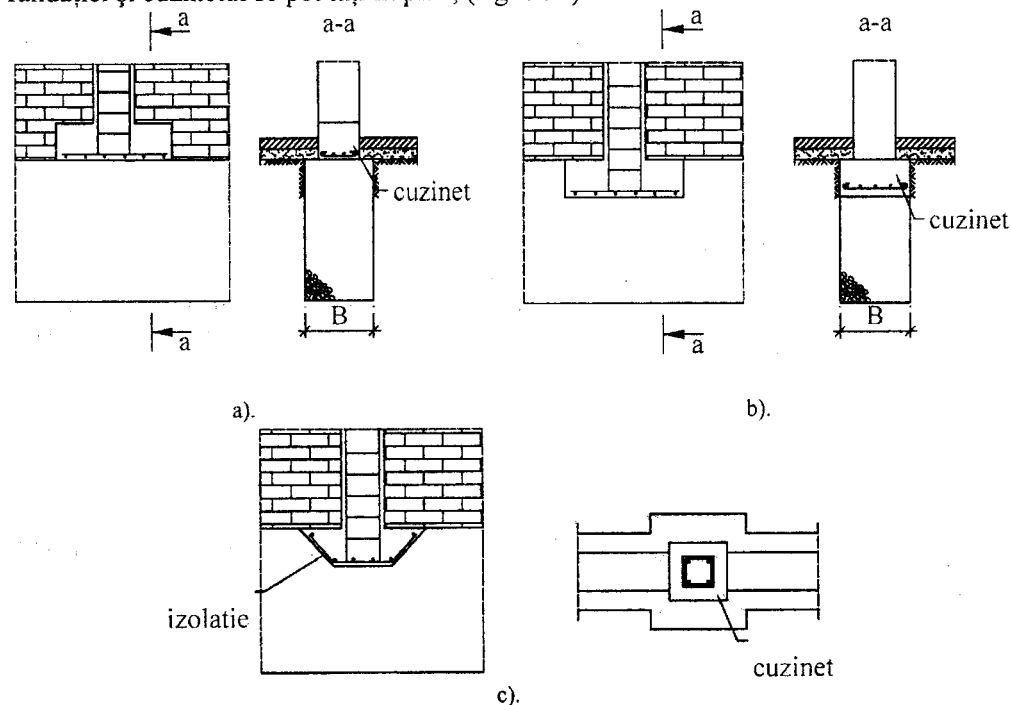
Fundarea pereților cu sămburi din beton armat
